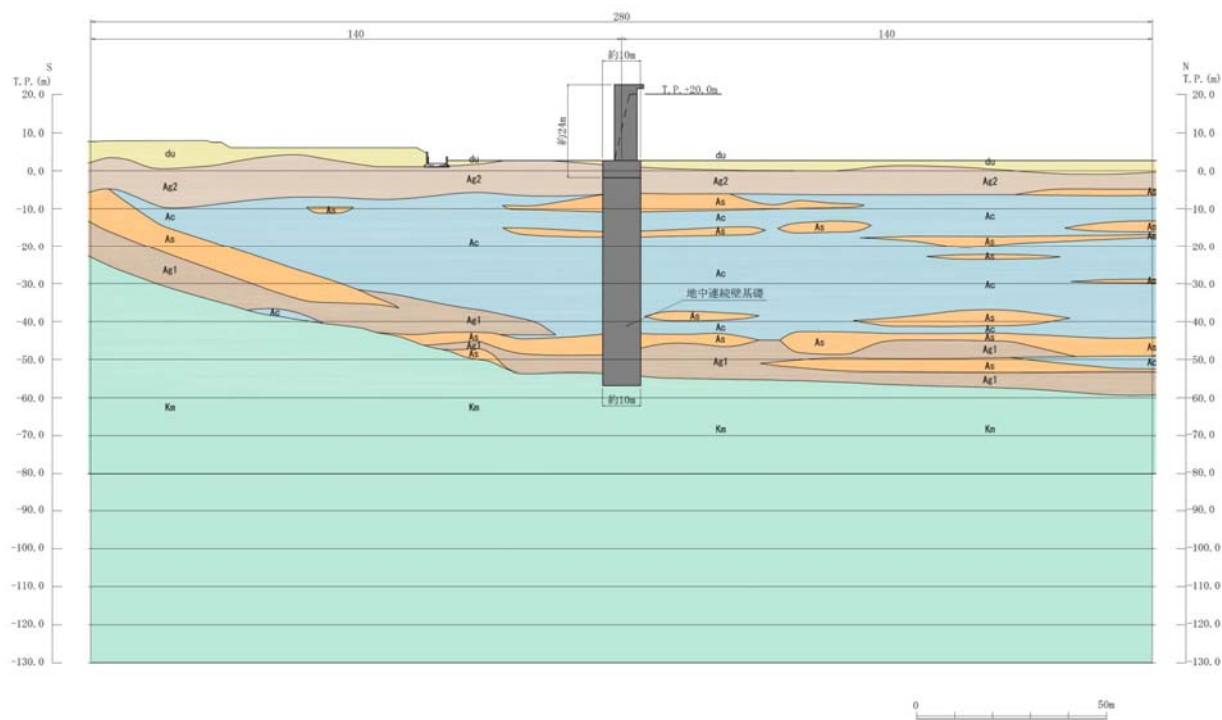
(1) 鉄筋コンクリート防潮壁 評価対象断面図 (①-①断面)
